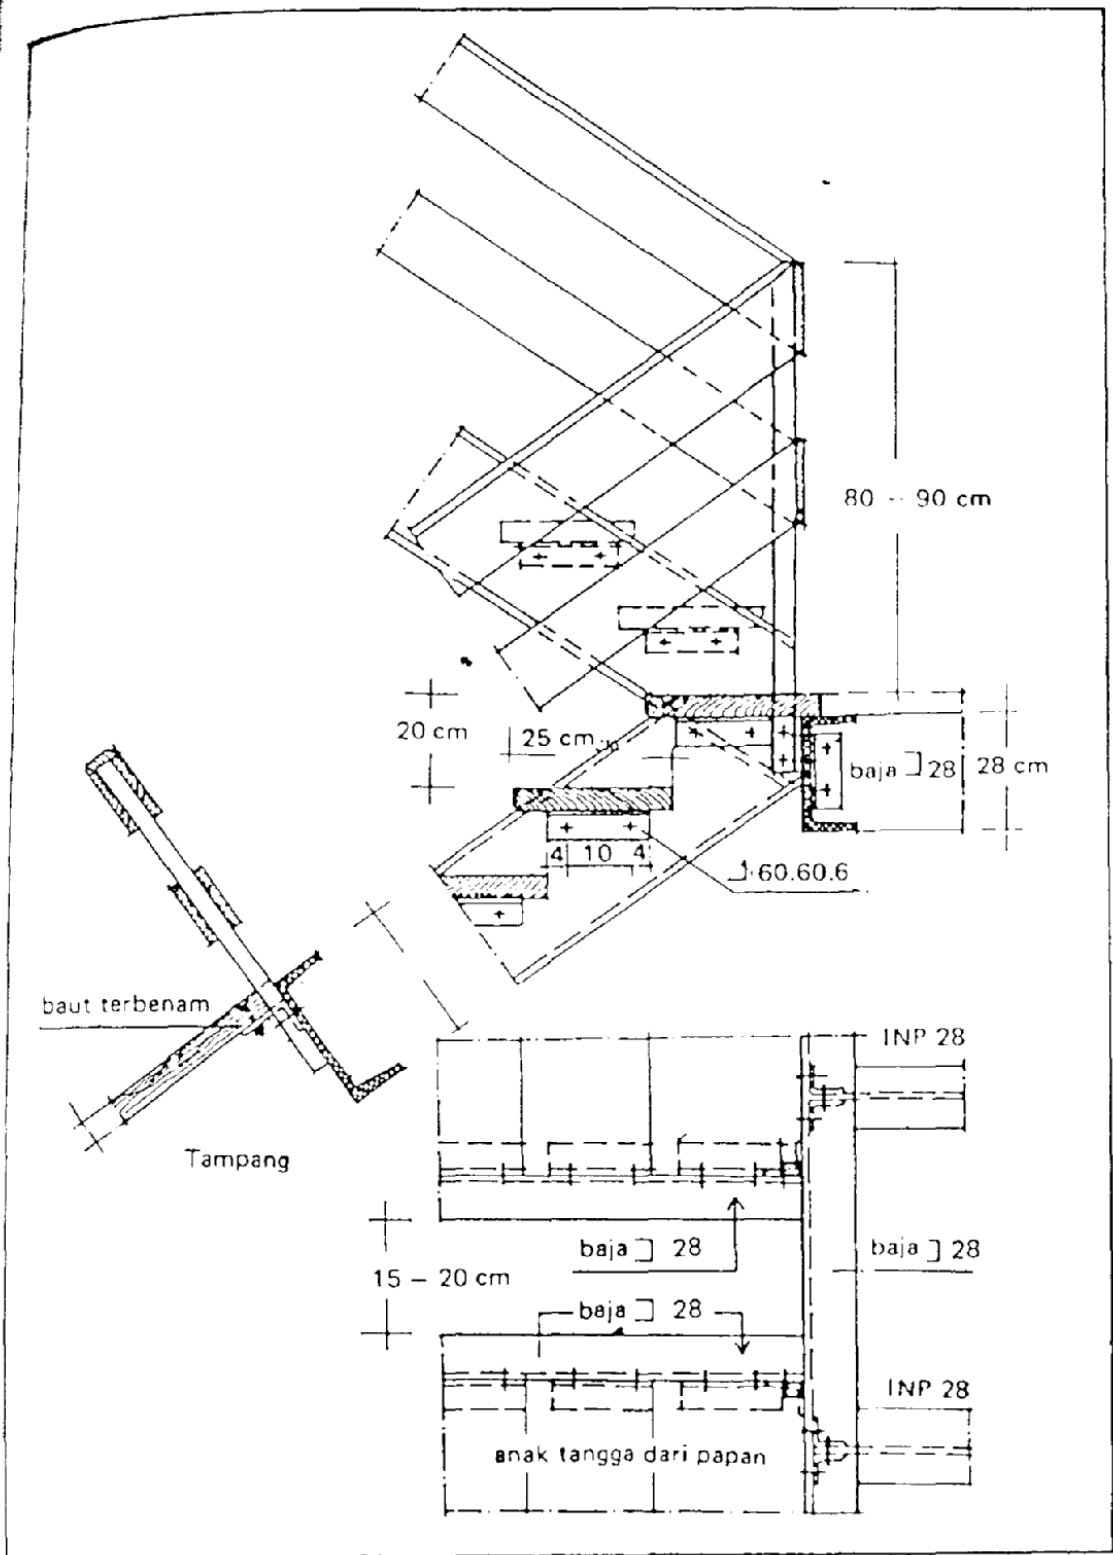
Tangga baja dari baja kanal anak tangga dari papan 4/25.
